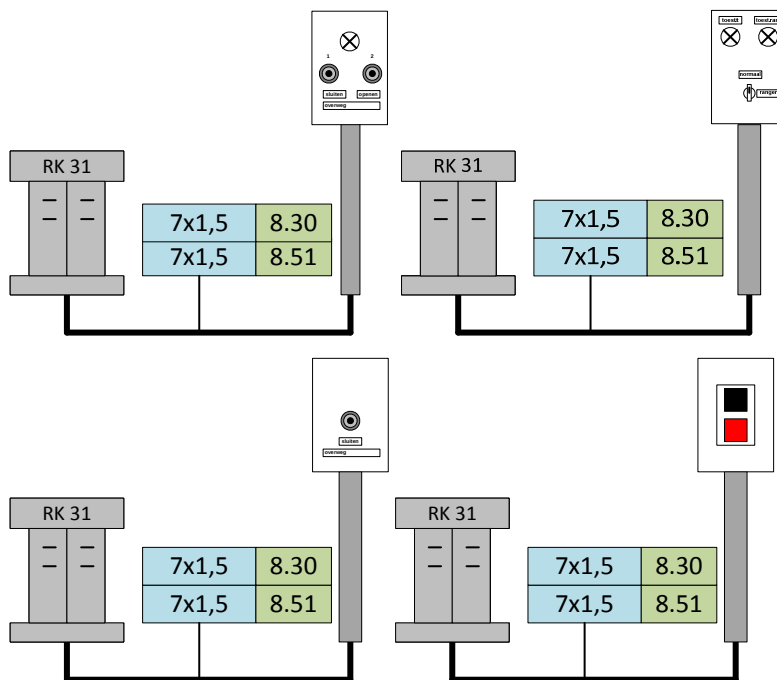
Kabel bij gekoppelde wisselaansturing.
